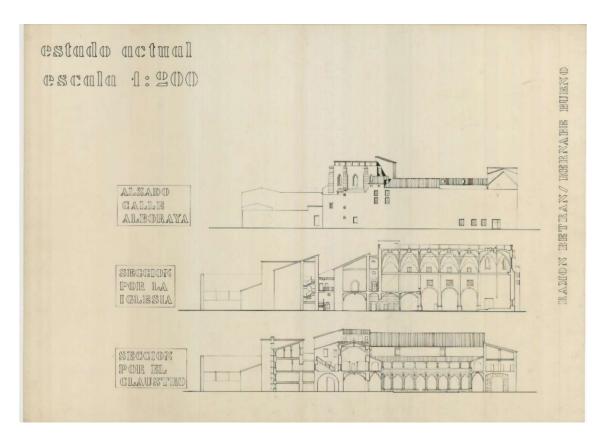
Plano de alzado recayente a la calle Iboraya, de sección por la Iglesia y de sección por el claustro.
